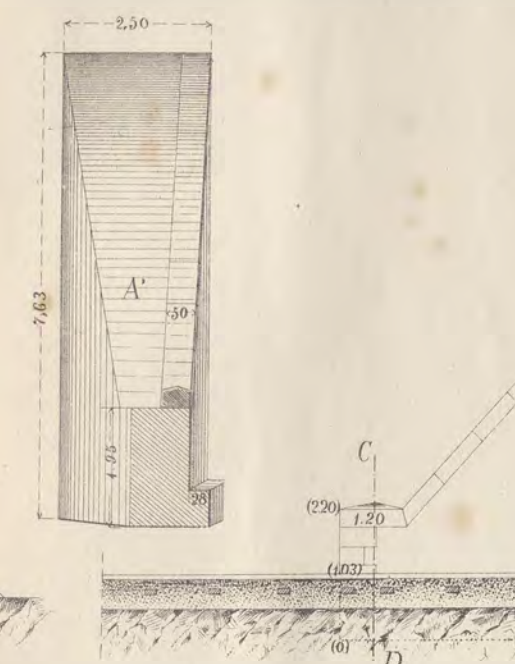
<sup>a</sup> Sezione longitudinale all'imbocco.
